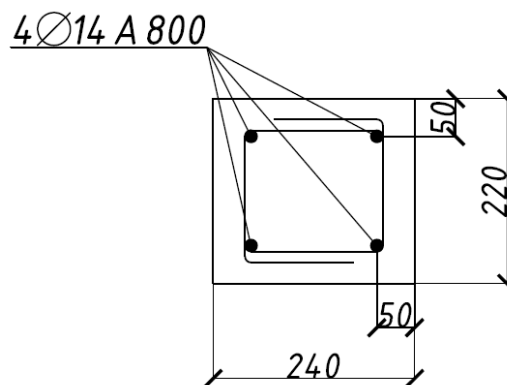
Армування поперечного перерізу нижнього поясу ферми
